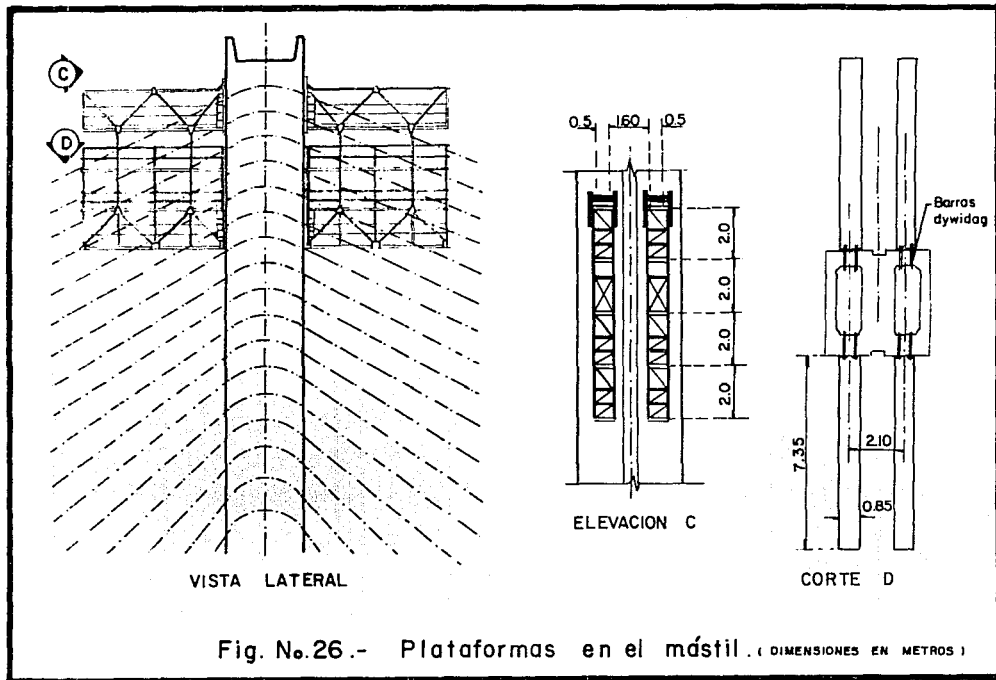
Plataformas en el mástil. (DIMENSIONES EN METROS)
